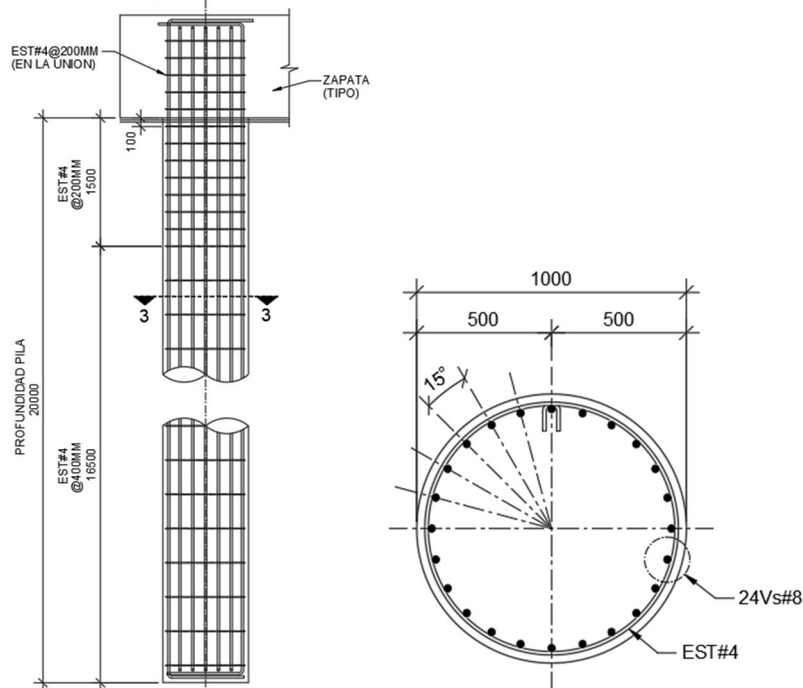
Dimensiones y armados propuestos de la pila PL-1
